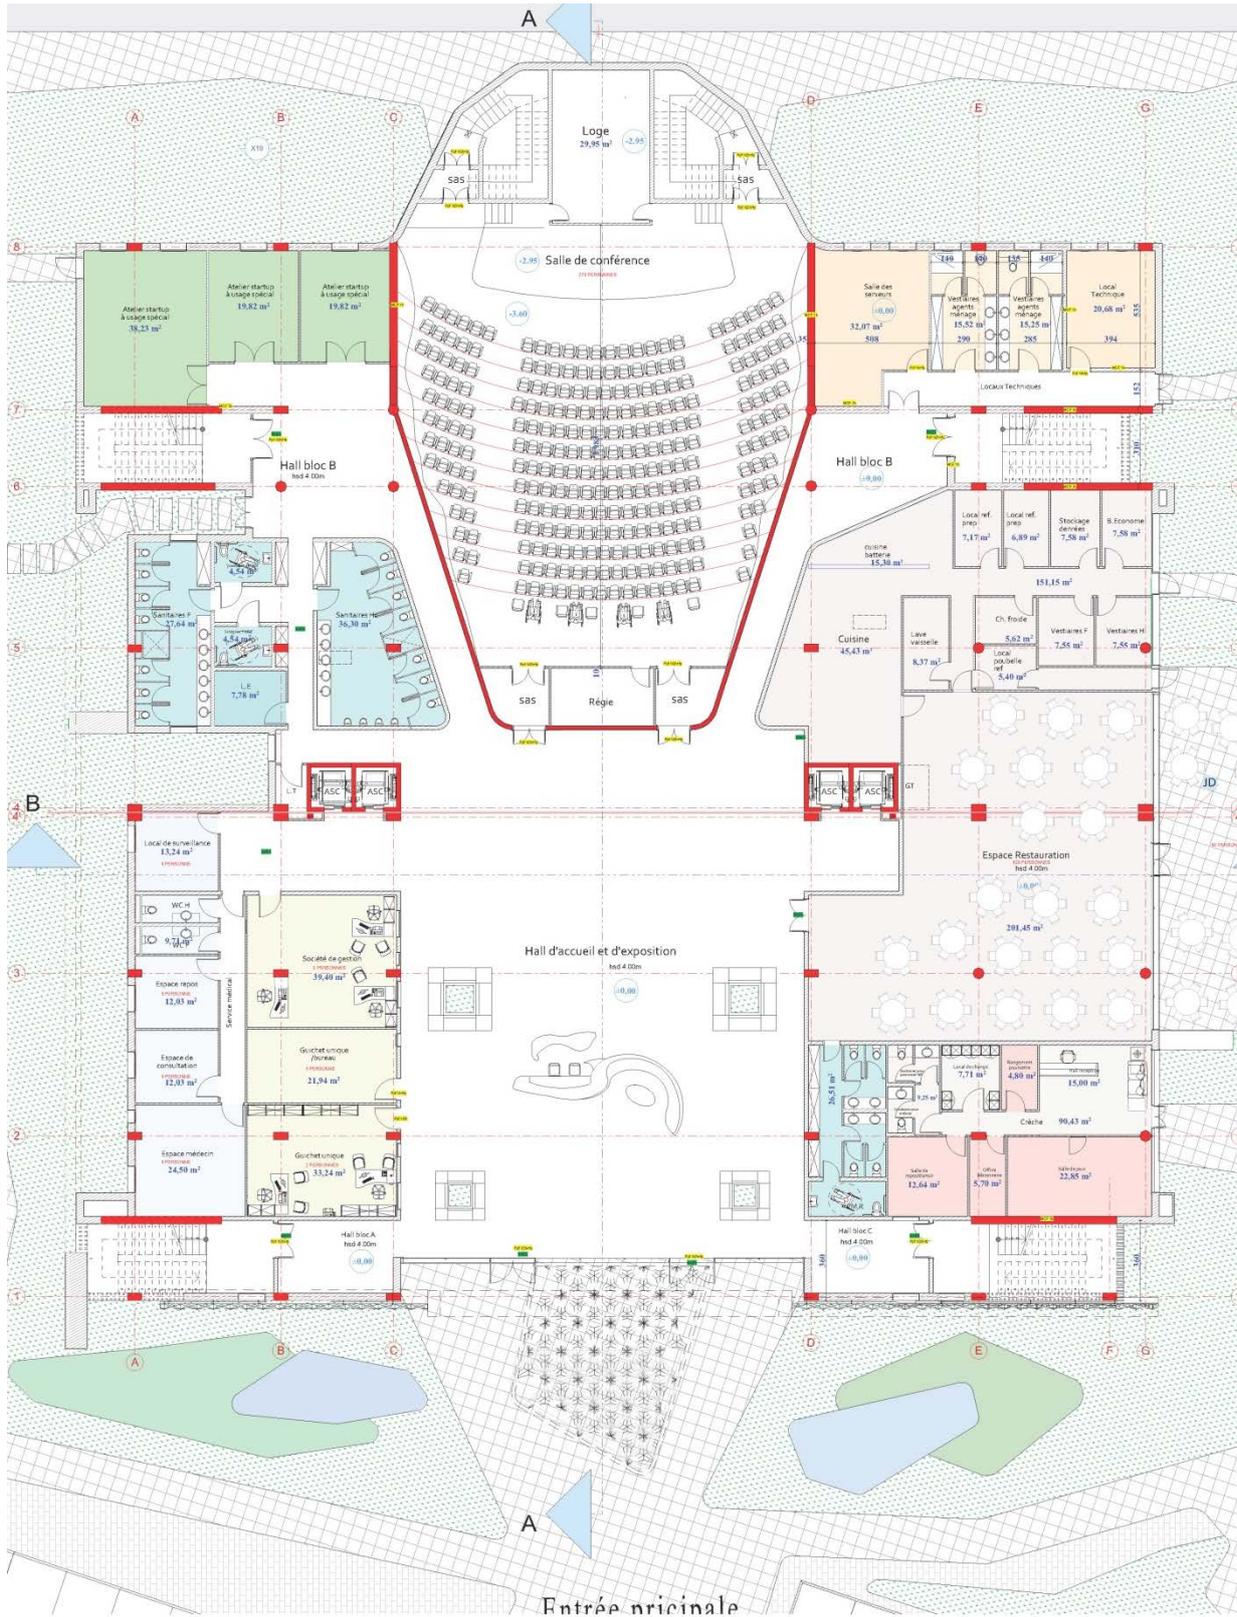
Plan masse du bâtiment de service de l'innovation et de l'usine modèle 4.0 (Rez-de-chaussée)
